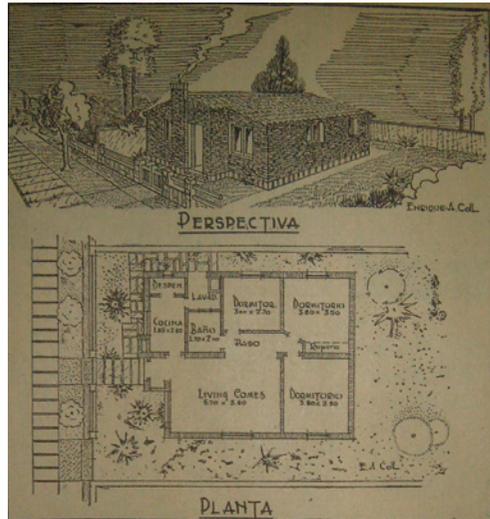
Figura IV: Vista y planta de la ampliación del barrio "4 de junio. Los Andes, 22 de abril de 1948, p. 5 / Perspectiva del barrio. Fuente: AHM
